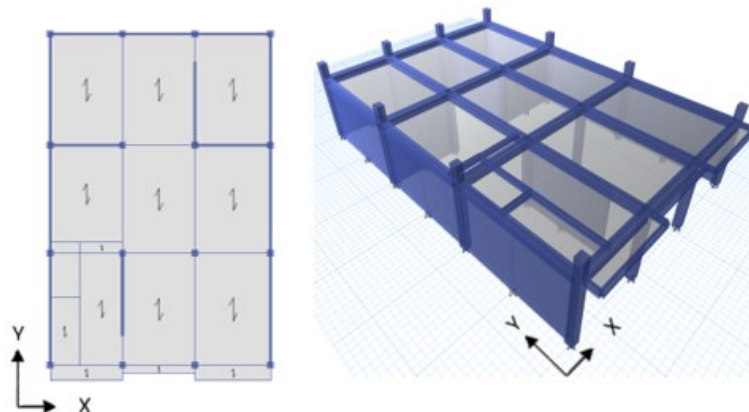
Vista en planta y 3D, tipología GIII(1P) – ETABS.
